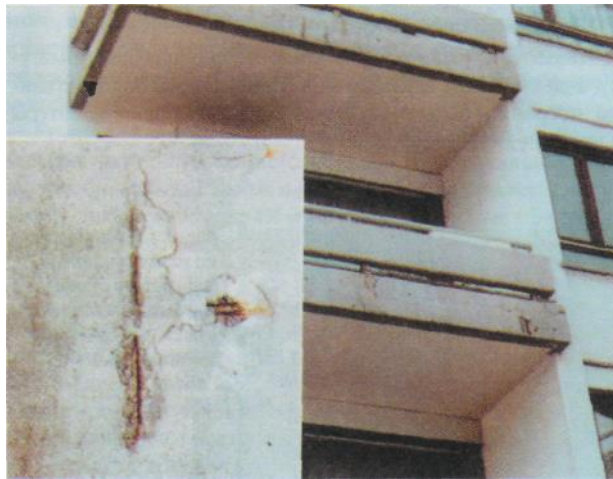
Характерні пошкодження збірних залізобетонних конструкцій будівель і споруд.
